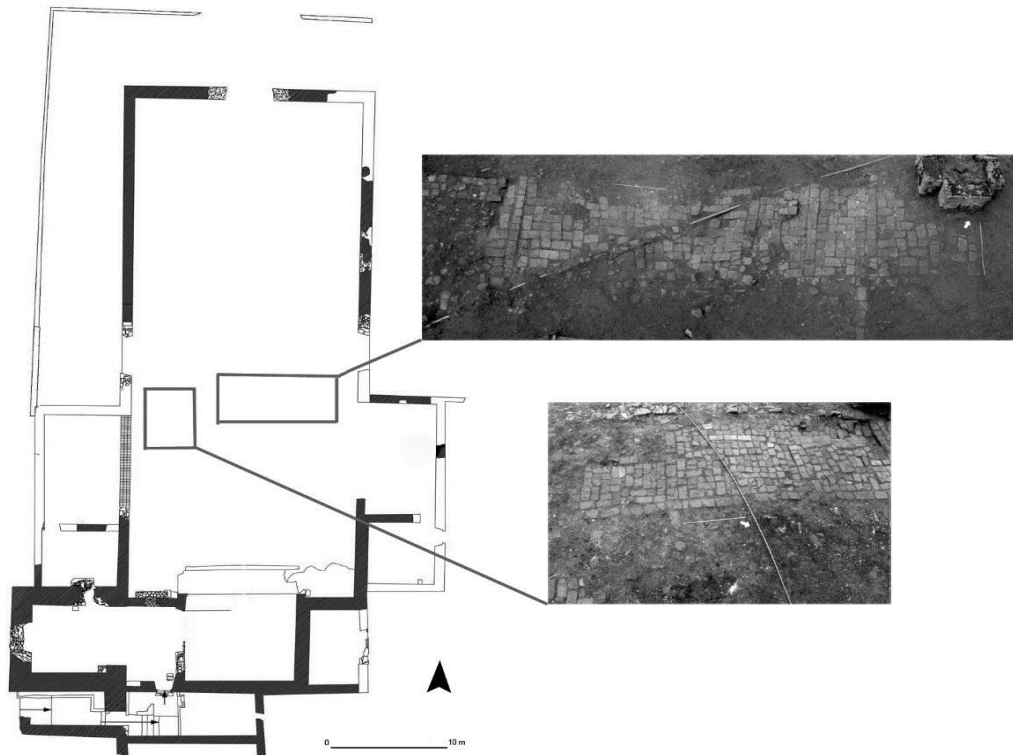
Imágenes tomadas del informe y ubicadas en los espacios donde fueron observados los elementos en el interior de la nave, se puede apreciar la tubería eléctrica que atraviesa el área, y en la imagen perteneciente al lado este, el diseño espina de pez en fragmentos del piso.
